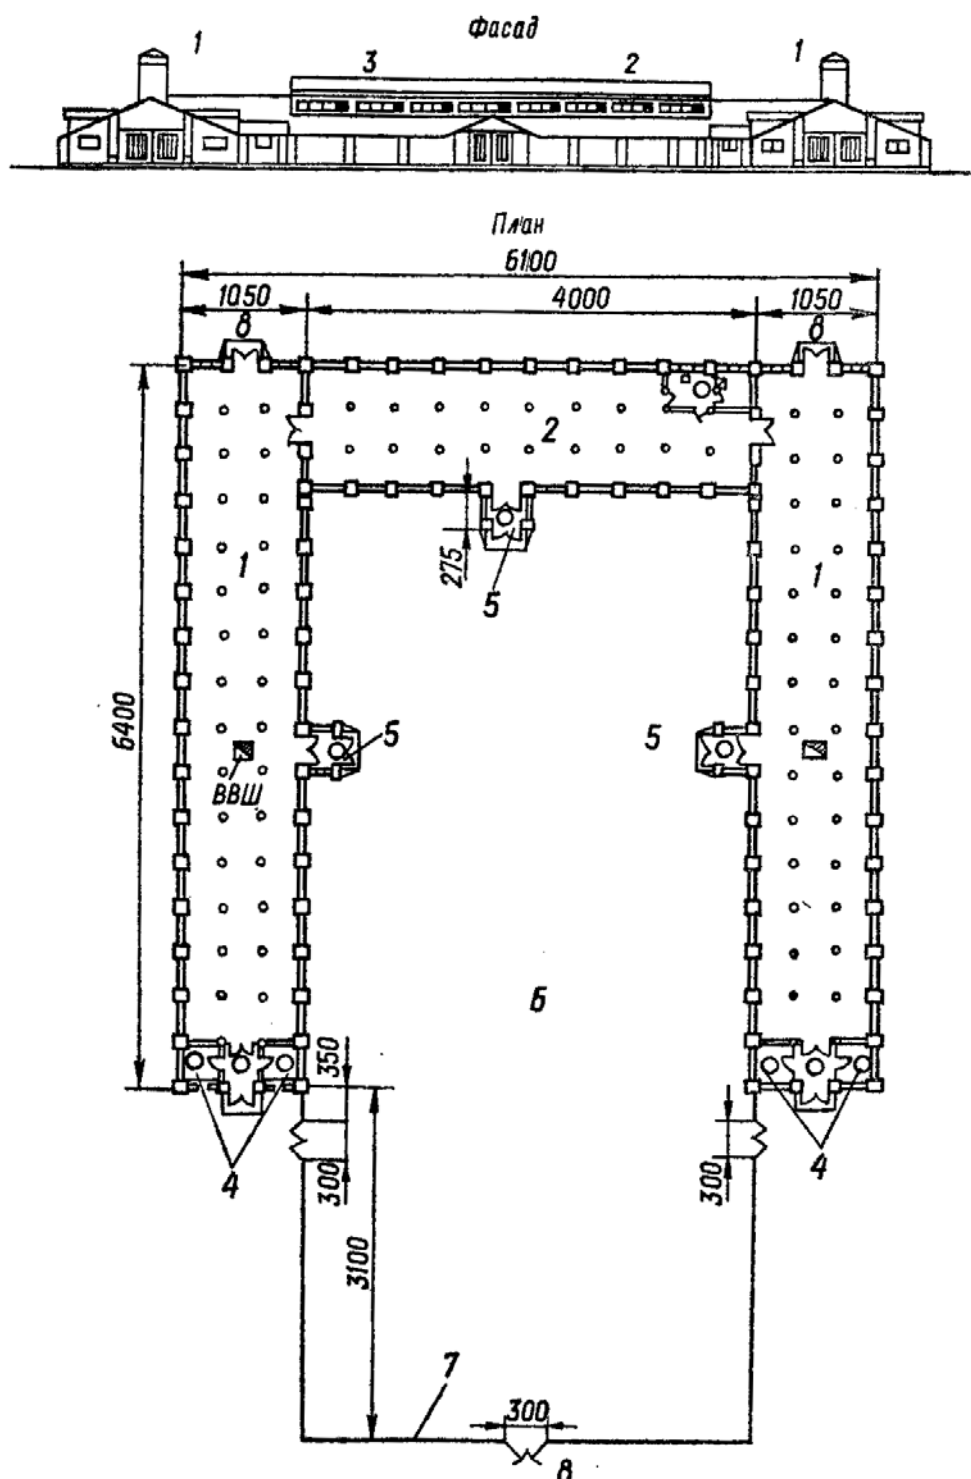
Вівчарня на 800 маток для зимового окоту. Фасад: 1 – витяжна вентиляційна труба; 2 – жалюзійні ґрати для припливу повітря; 3 – вікна. План: 1 – приміщення для вівцематок; 2 – приміщення для окоту (тепляк); 3 – пункт штучного осіменіння; 4 – фуражне і інвентарне відділення; 5 – тамбури; 6 – відкритий баз; 7 – огороження базу; 8 – ворота.
